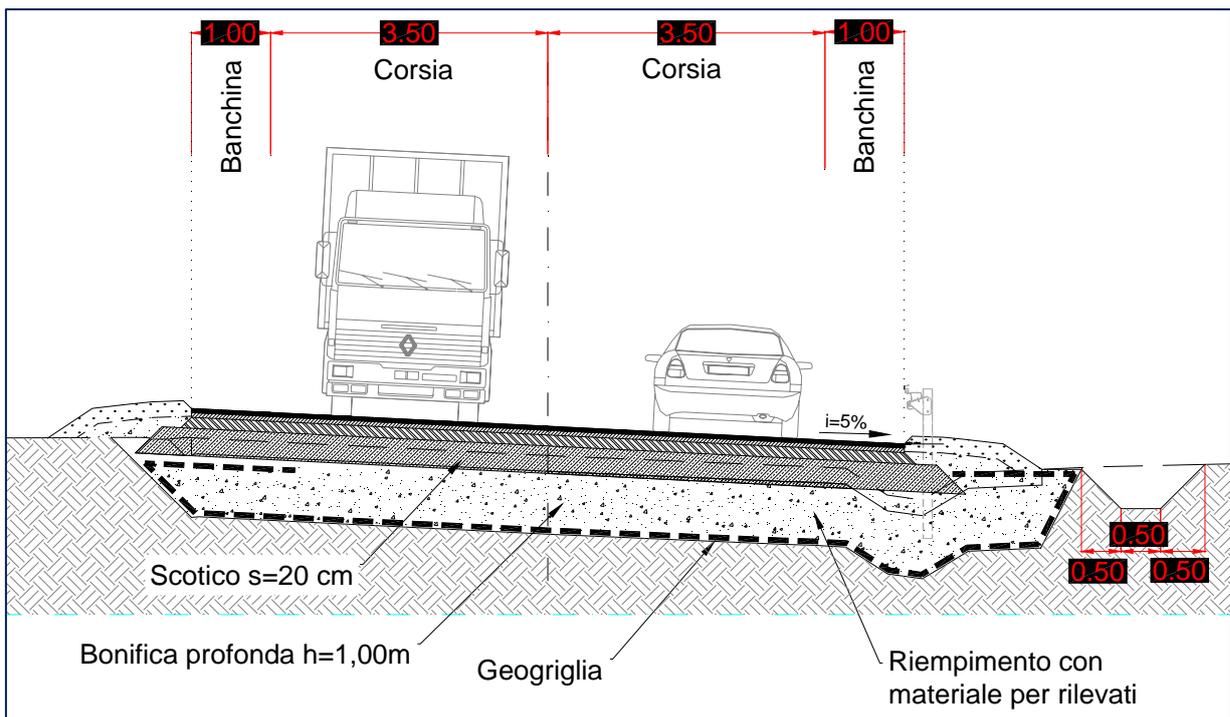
sezione tipo S.S.1 Via Aurelia
